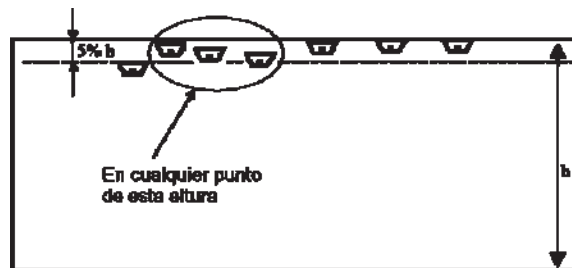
Emplazamiento y separación bajo falsos techos.
